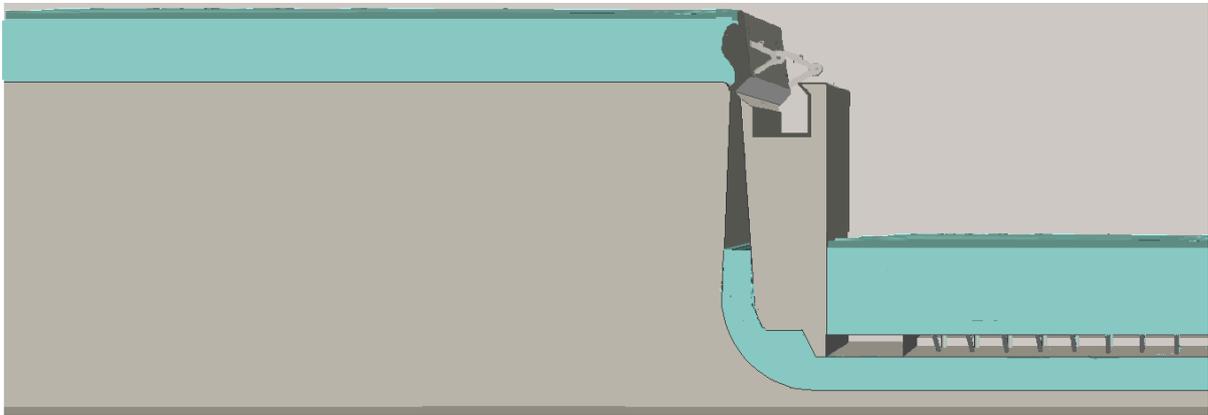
Neues vereinfachtes Füllsystem für Fallhöhen > 10 m mit horizontalem Fallschacht
